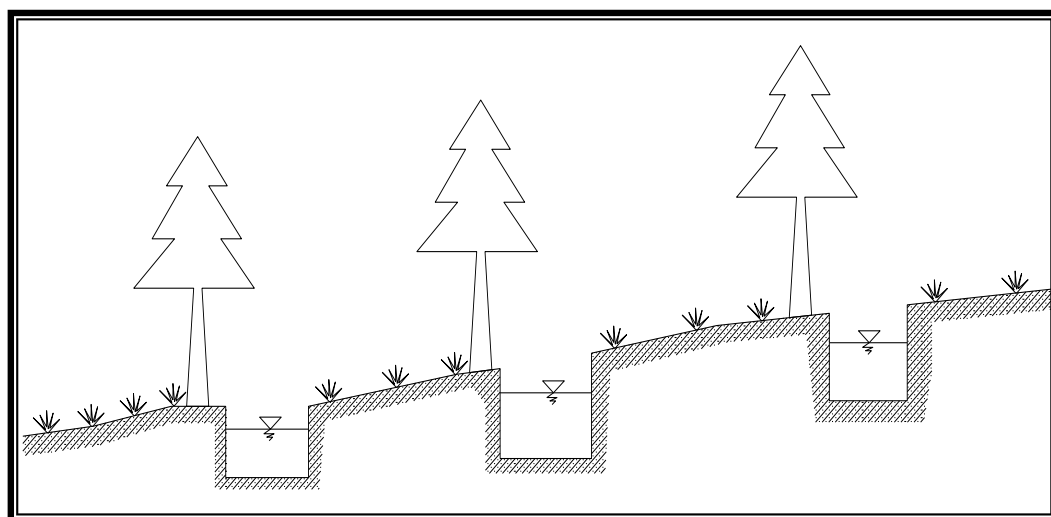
Zanjas de infiltración vista en perfil forestado con árboles nativos
